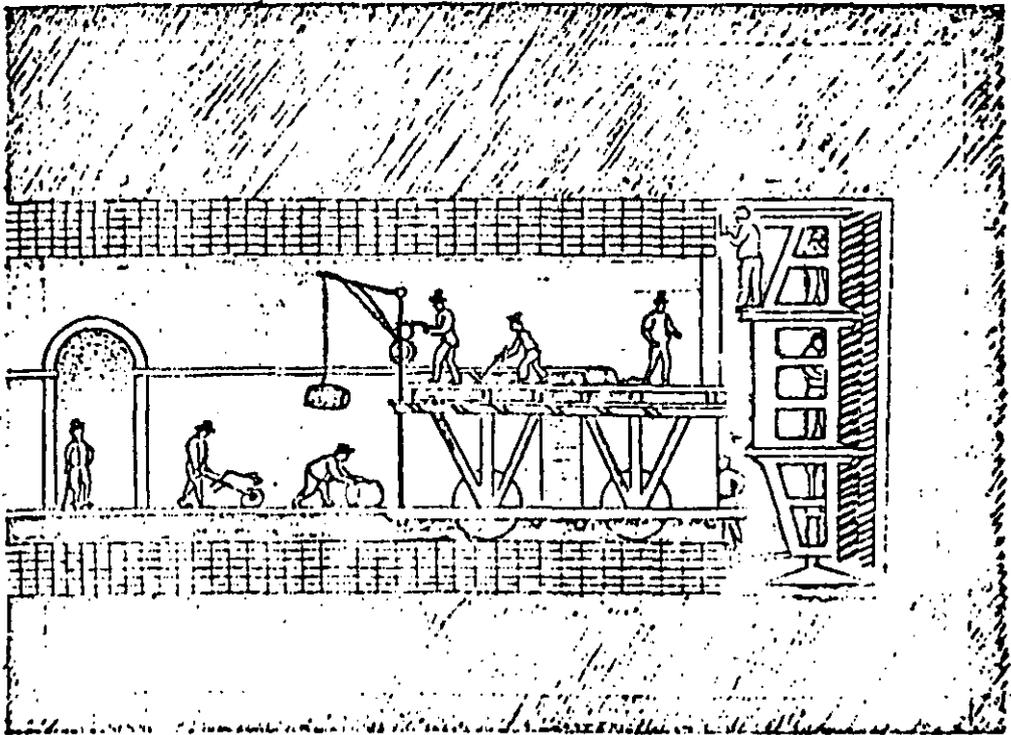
Excavación bajo e Tómesis usando el Escudo de Brunel.
